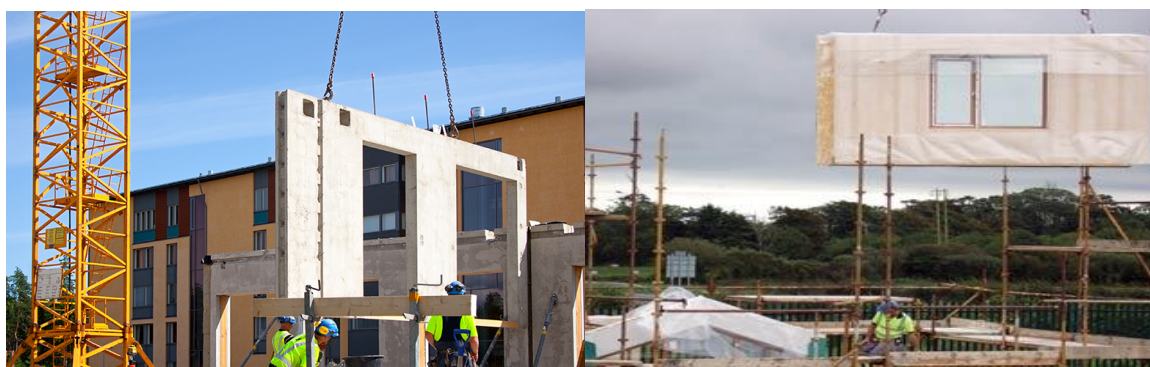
a) Montagem de painéis pré-fabricados; b) Montagem de painel de madeira
